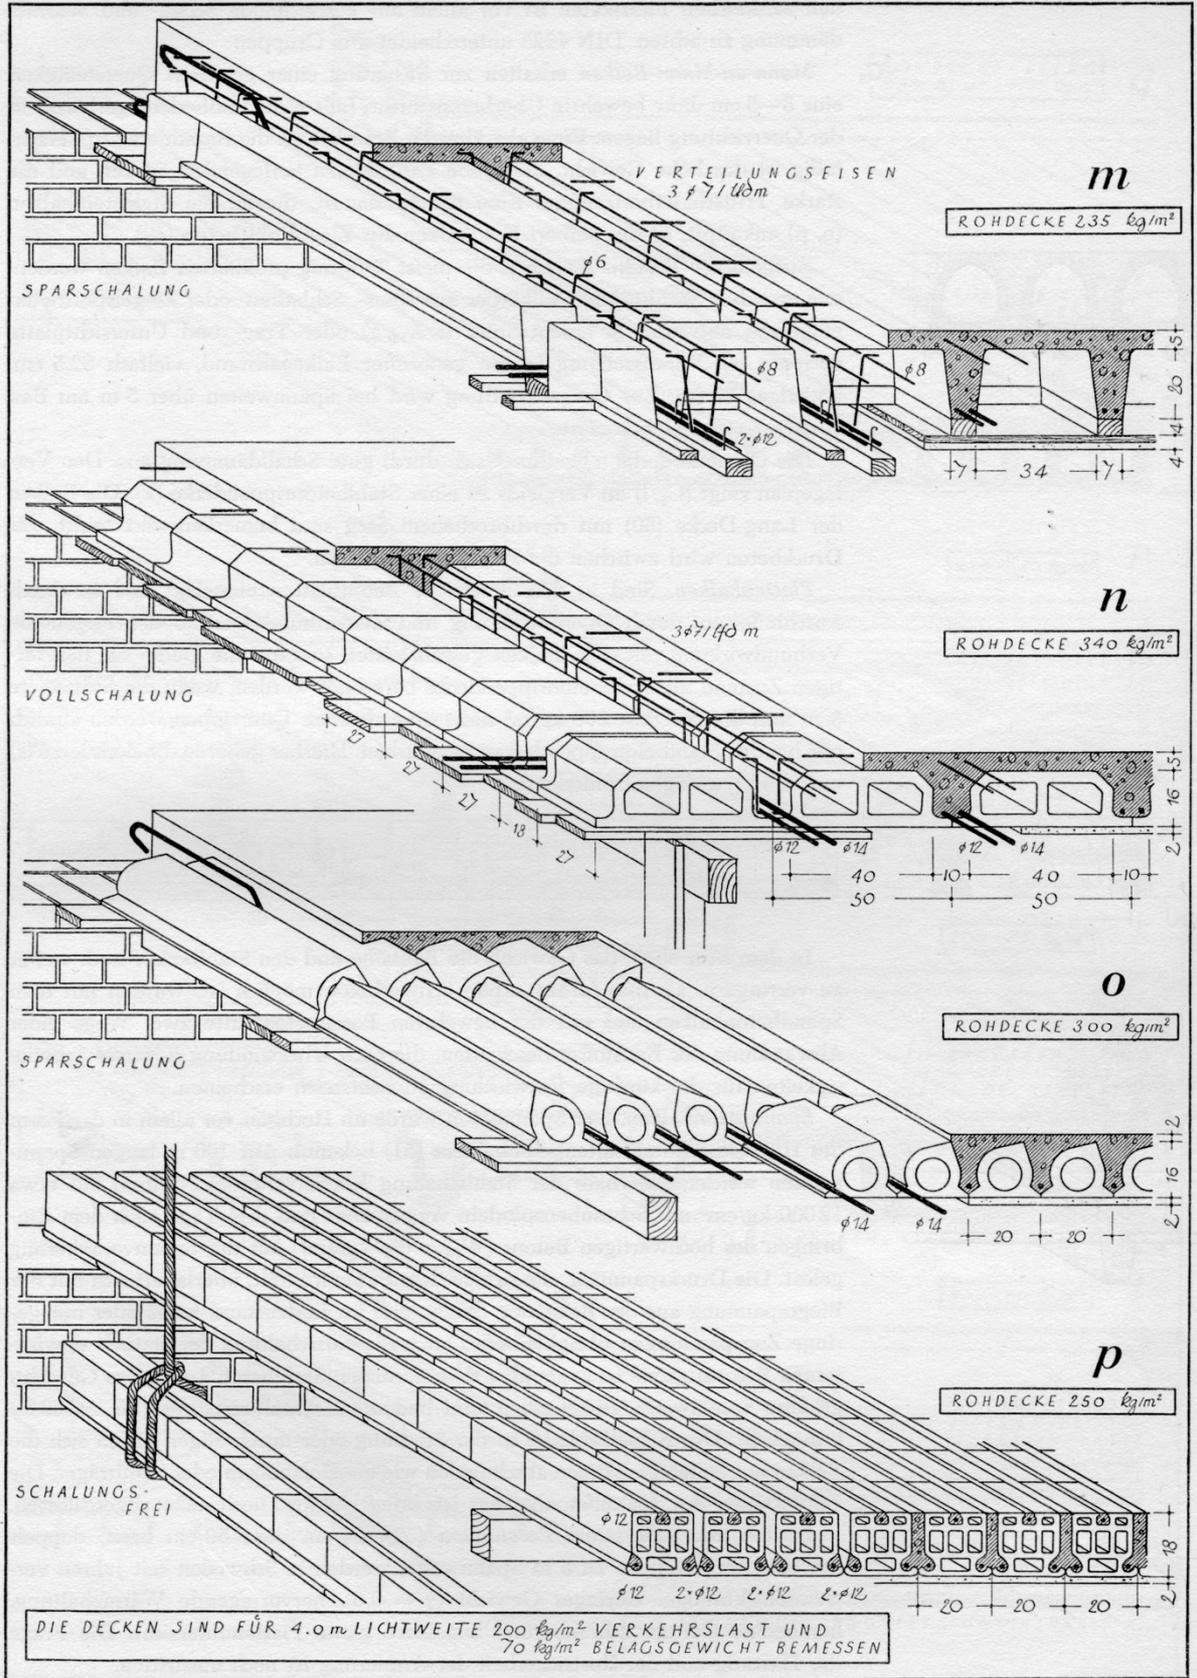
Stahlbetonrippen und Stahlsteindecken aus F. Hart, Baukonstruktion für Architekten, 1950
